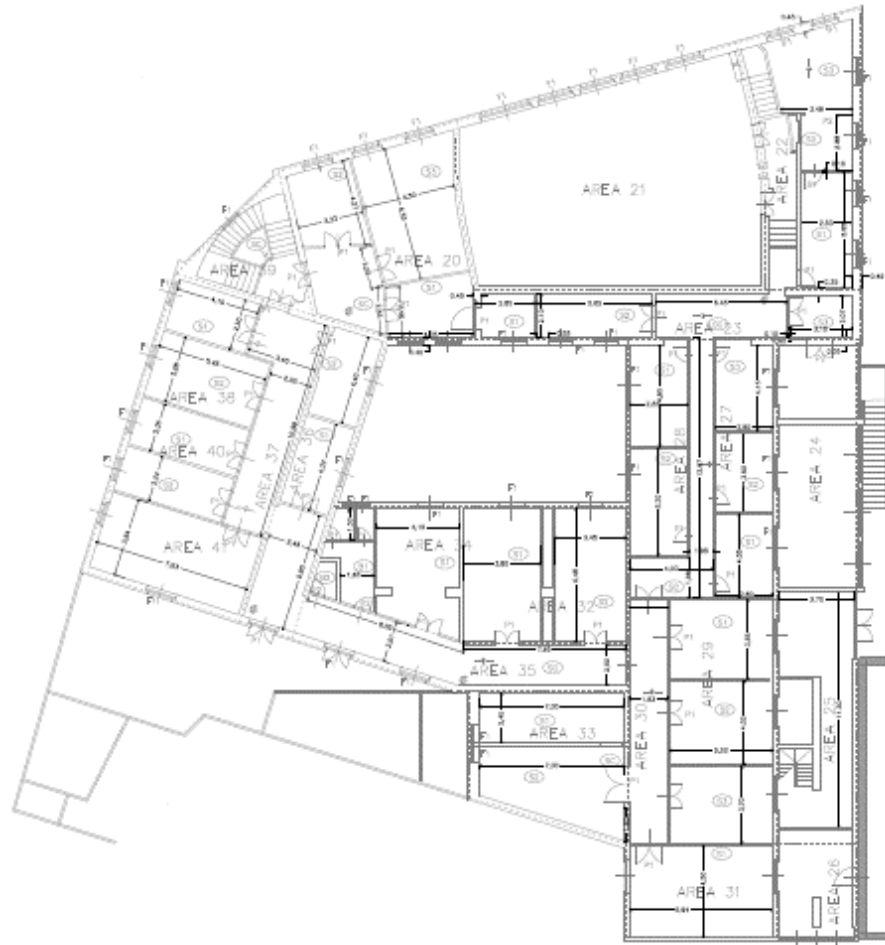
2: Planimetria Dipartimento di Ingegneria Elettrica, Primo Piano
